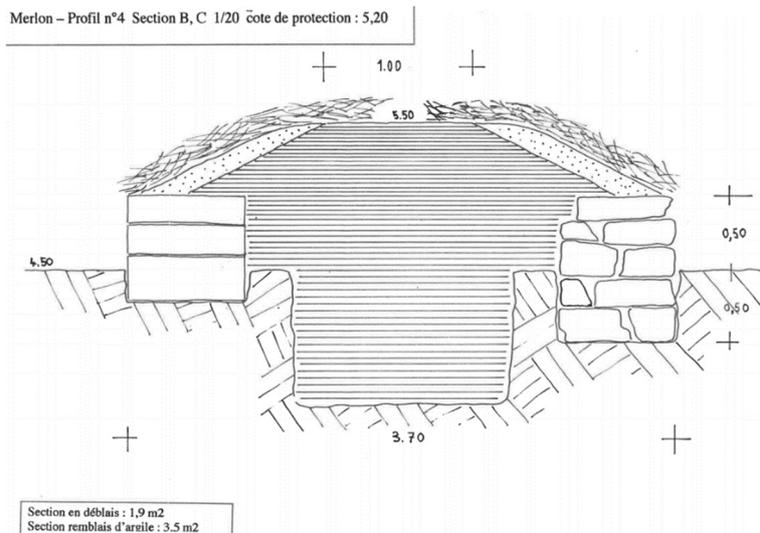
Coupe projet "section B, C" du tronçon 6 (G. Chauvel)
